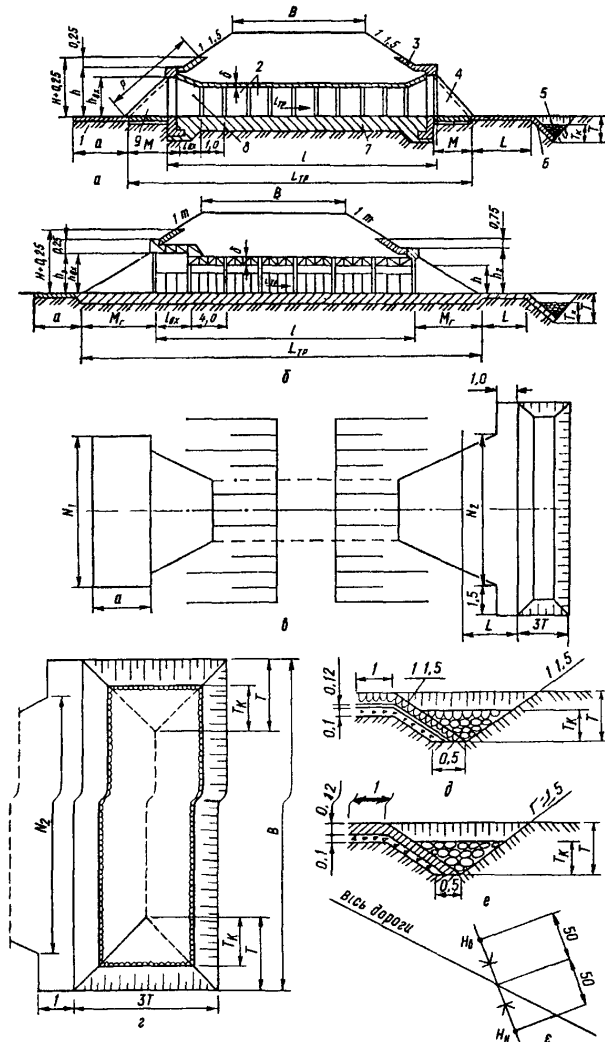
Укріплення русел і укосів біля водоперепускних труб
